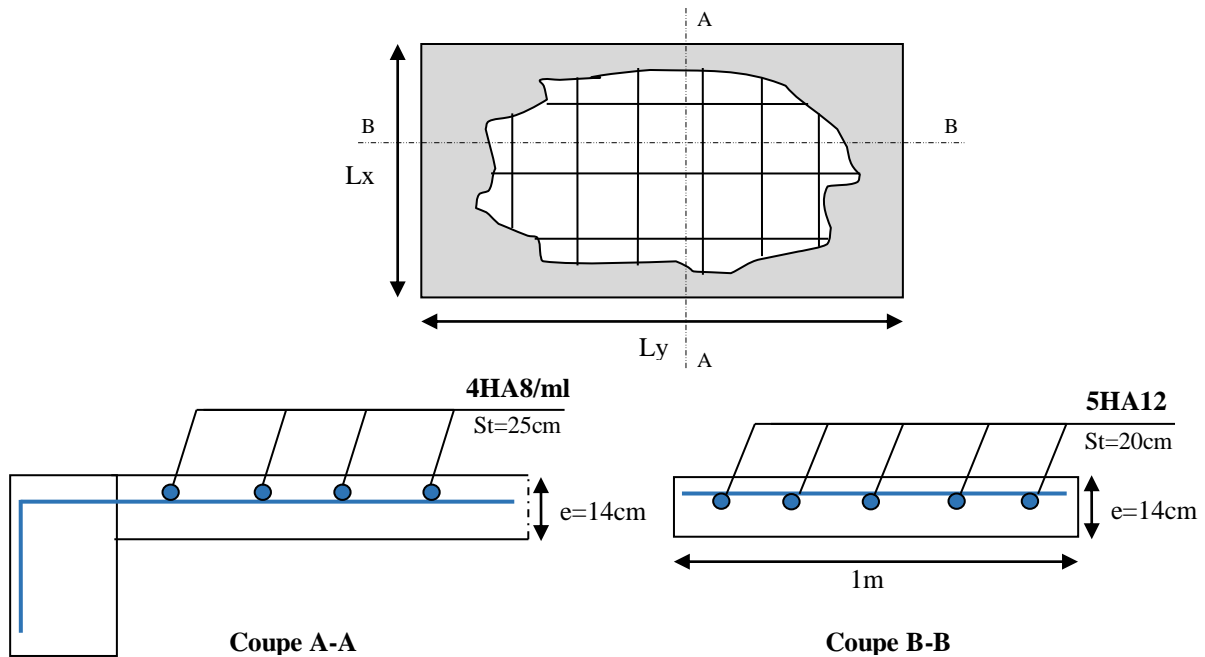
Schéma de ferrailage de panneau de dalle D1
